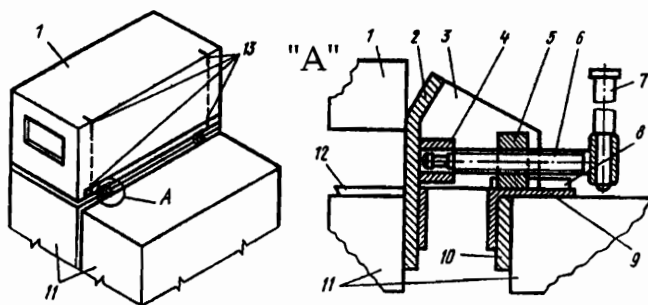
Схема установки монтажных упорных фиксаторов: 1 – монтируемый блок; 2 – фиксирующая плоскость; 3 – упор; 4 – пята; 5 – гайка; 6 – винт; 7 – вороток; 8 – направляющая упора; 9 – опорный уголок; 10 – прижимная планка; 11 – смонтированные блоки; 12 – опорный уголок; 13 – монтажные установочные риски
